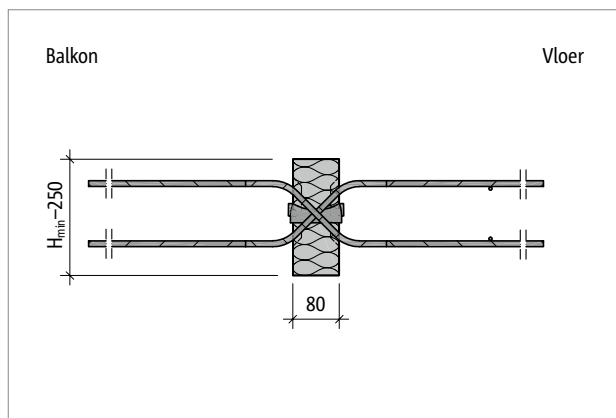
Schöck Isokorf® T type Q-E-Z-W-V5 bij R0: Zijaanzicht
